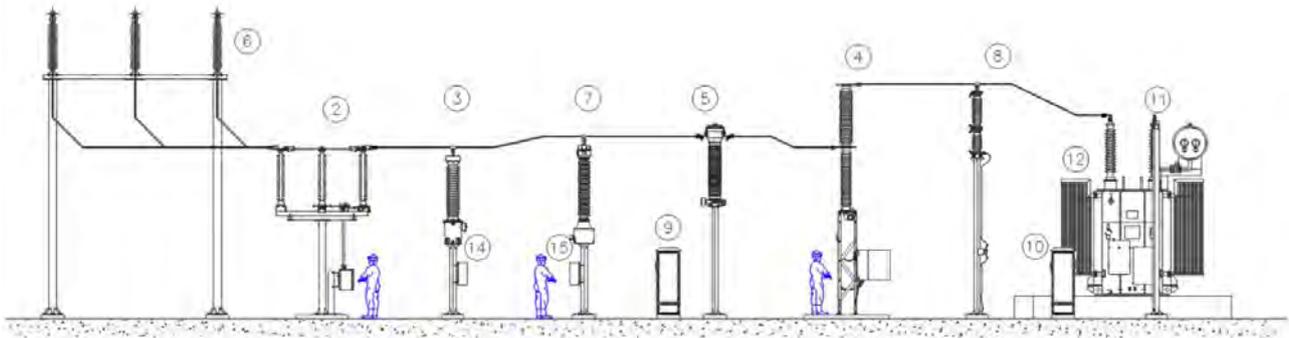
Planimetria stazione di trasformazione utente 150/30 kV e area comune
